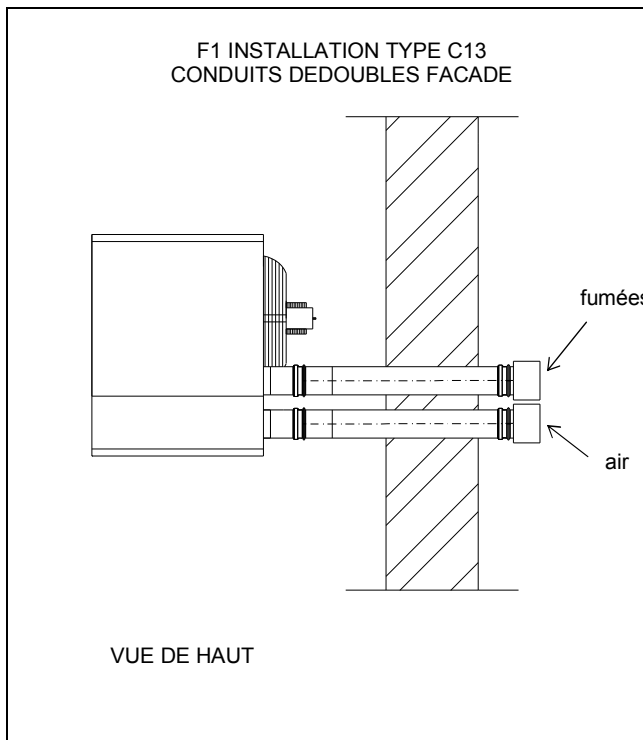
F1 INSTAL.TYPE C13 CONDUITS DEDOUBLES FACADE
